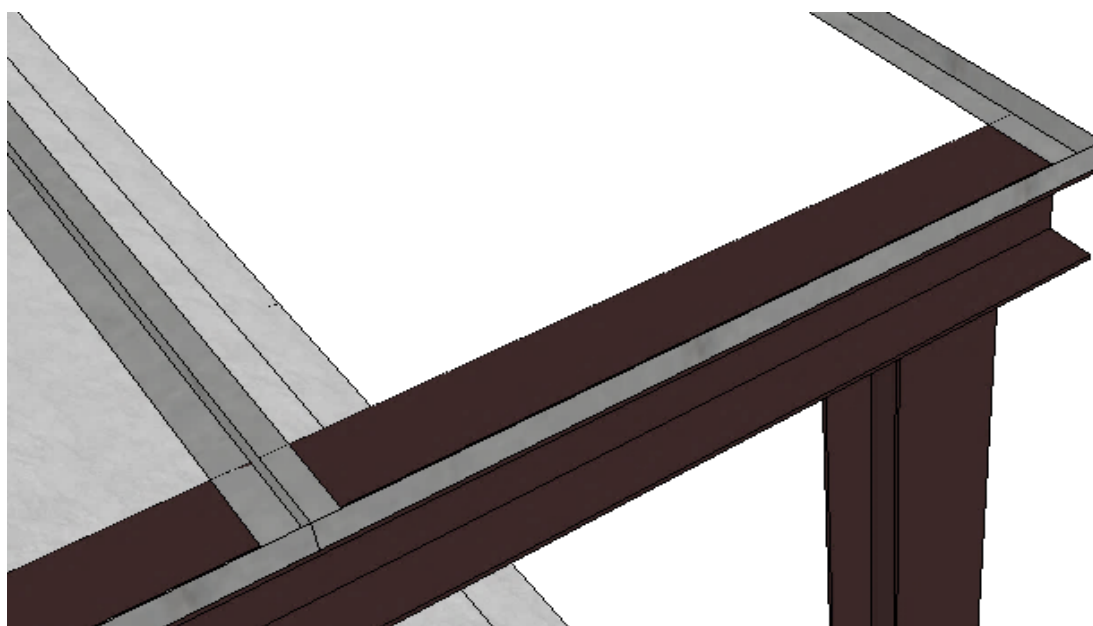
Detalle de junta de unión entre viga H y angulares.
